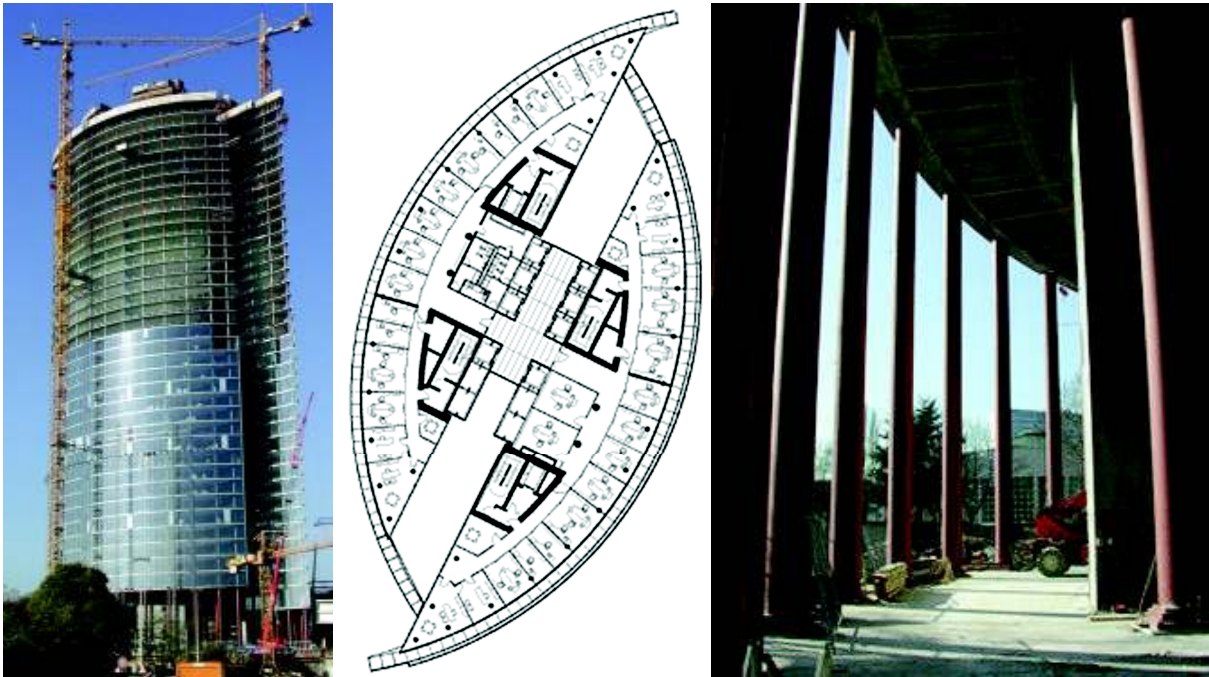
Seitenansicht (links), Grundriss (Mitte) und Foyerstützen im Bauzustand (rechts) des Post Tower in Bonn [Mitte: www.wsi-stuttgart.de, rechts: www.spannverbund.de]
